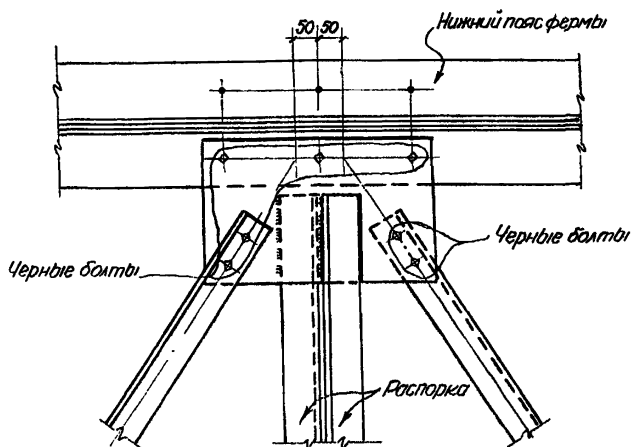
Крепление крестов связей по нижним поясам ферм на общих фасонках с распорками
